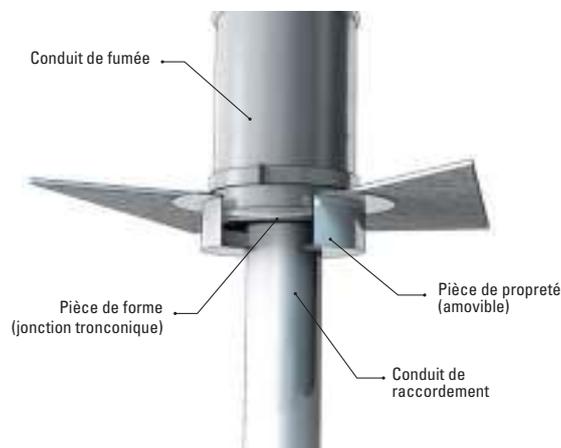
Exemple de jonction du conduit de fumée et du conduit de raccordement au plafond
